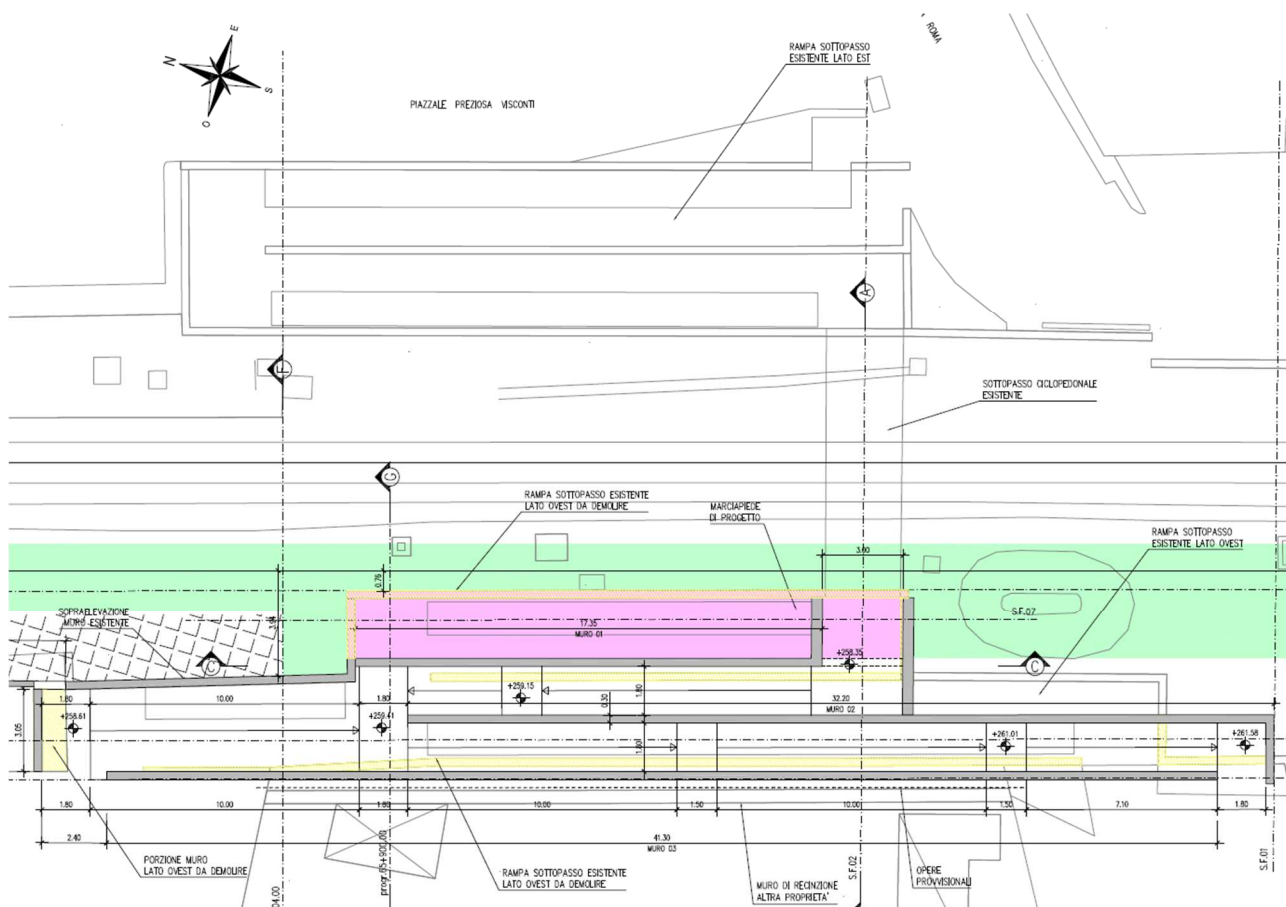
Pianta sottopasso ciclopeditonale via Roma
